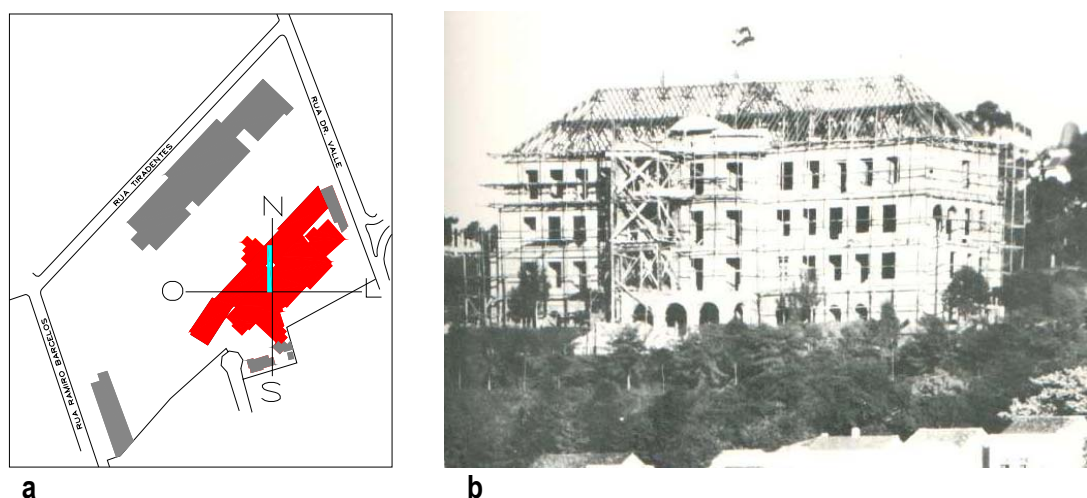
Implantação do HMV (destacado) (a) e vista externa durante a construção (b)
